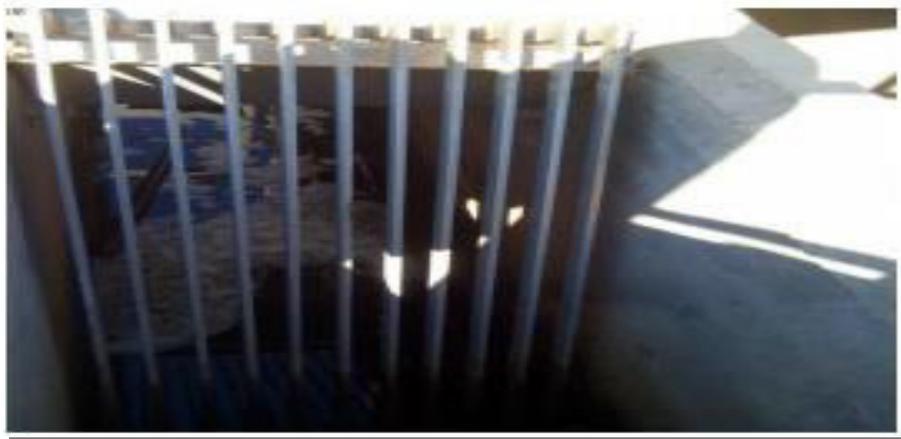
Dégrillage de la station d'épuration de Sidi Khouiled
